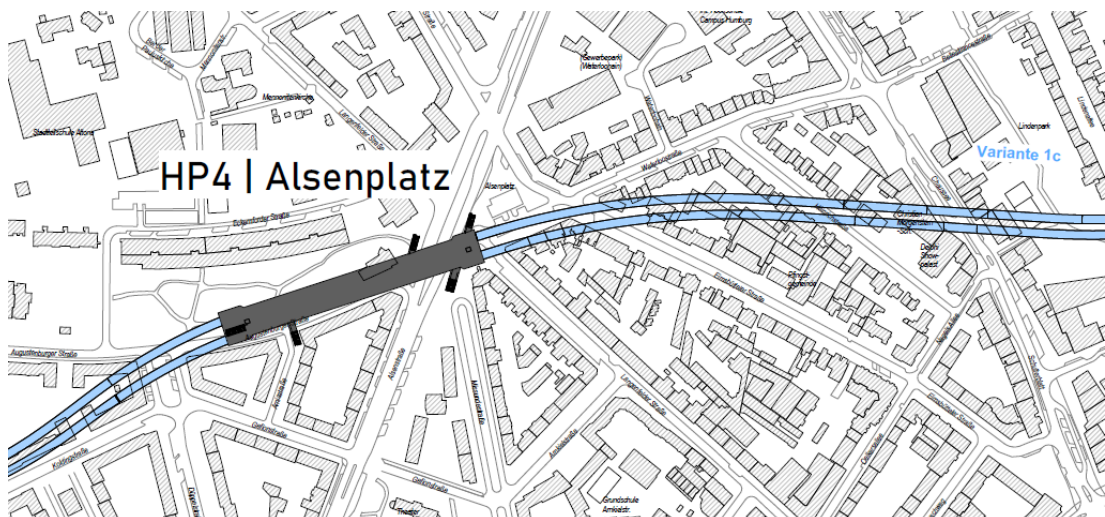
Lageplan Stationsbauwerk HP 4 Alsenplatz, Variante 1c (hellblau), Station II (Variantenstudie).
